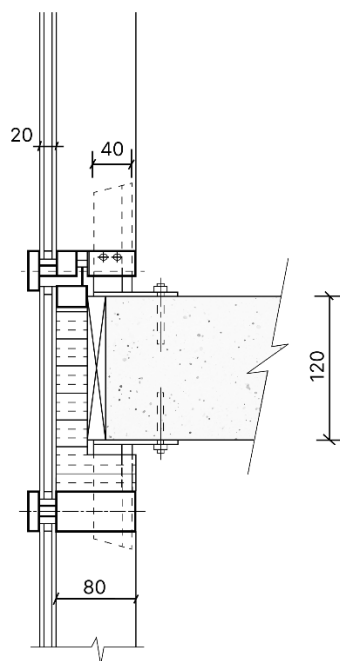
Збільшений фрагмент у зоні міжповерхового перекриття
